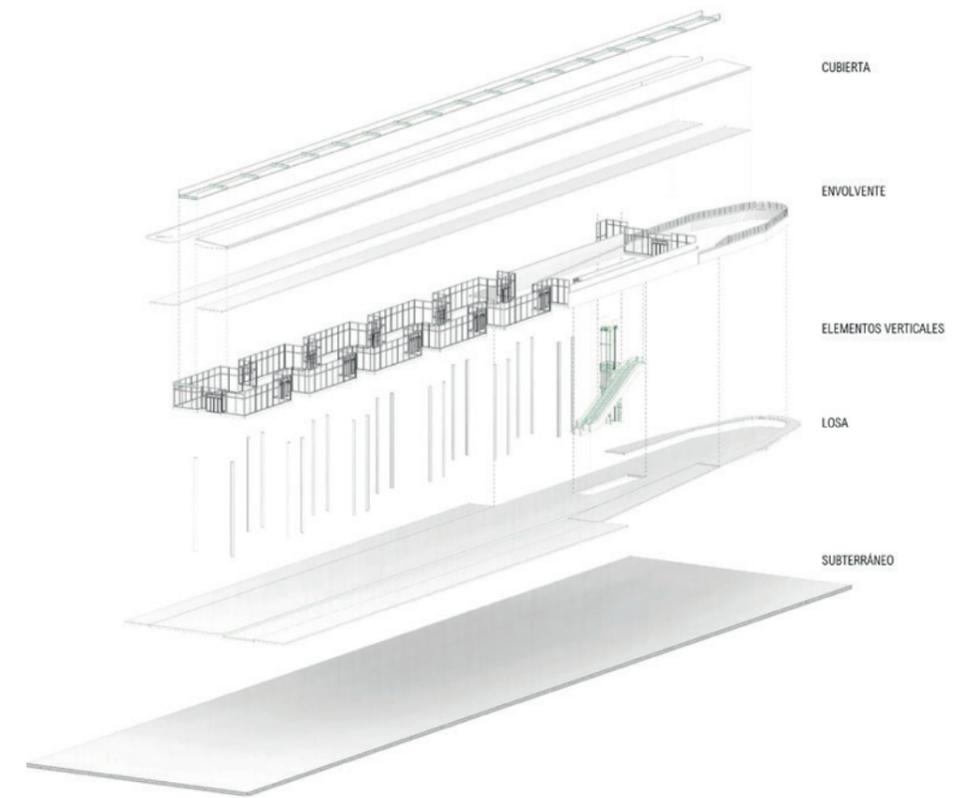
Levantamiento sitio Santa Rosa/ Departamental. Fuente: Elaboración propia
